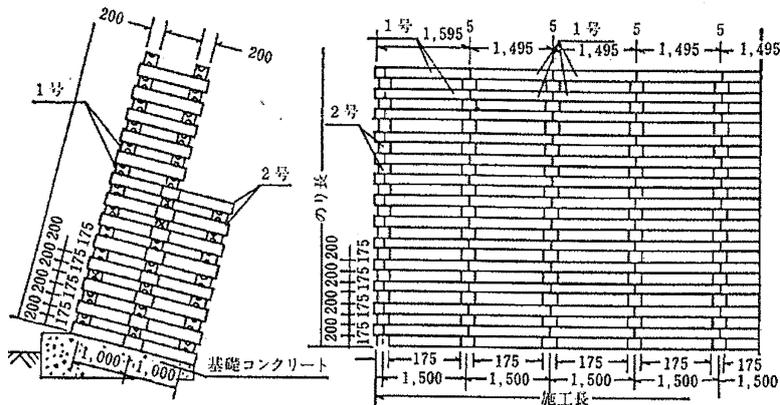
井桁組擁壁工の一例 (単位 : mm)
